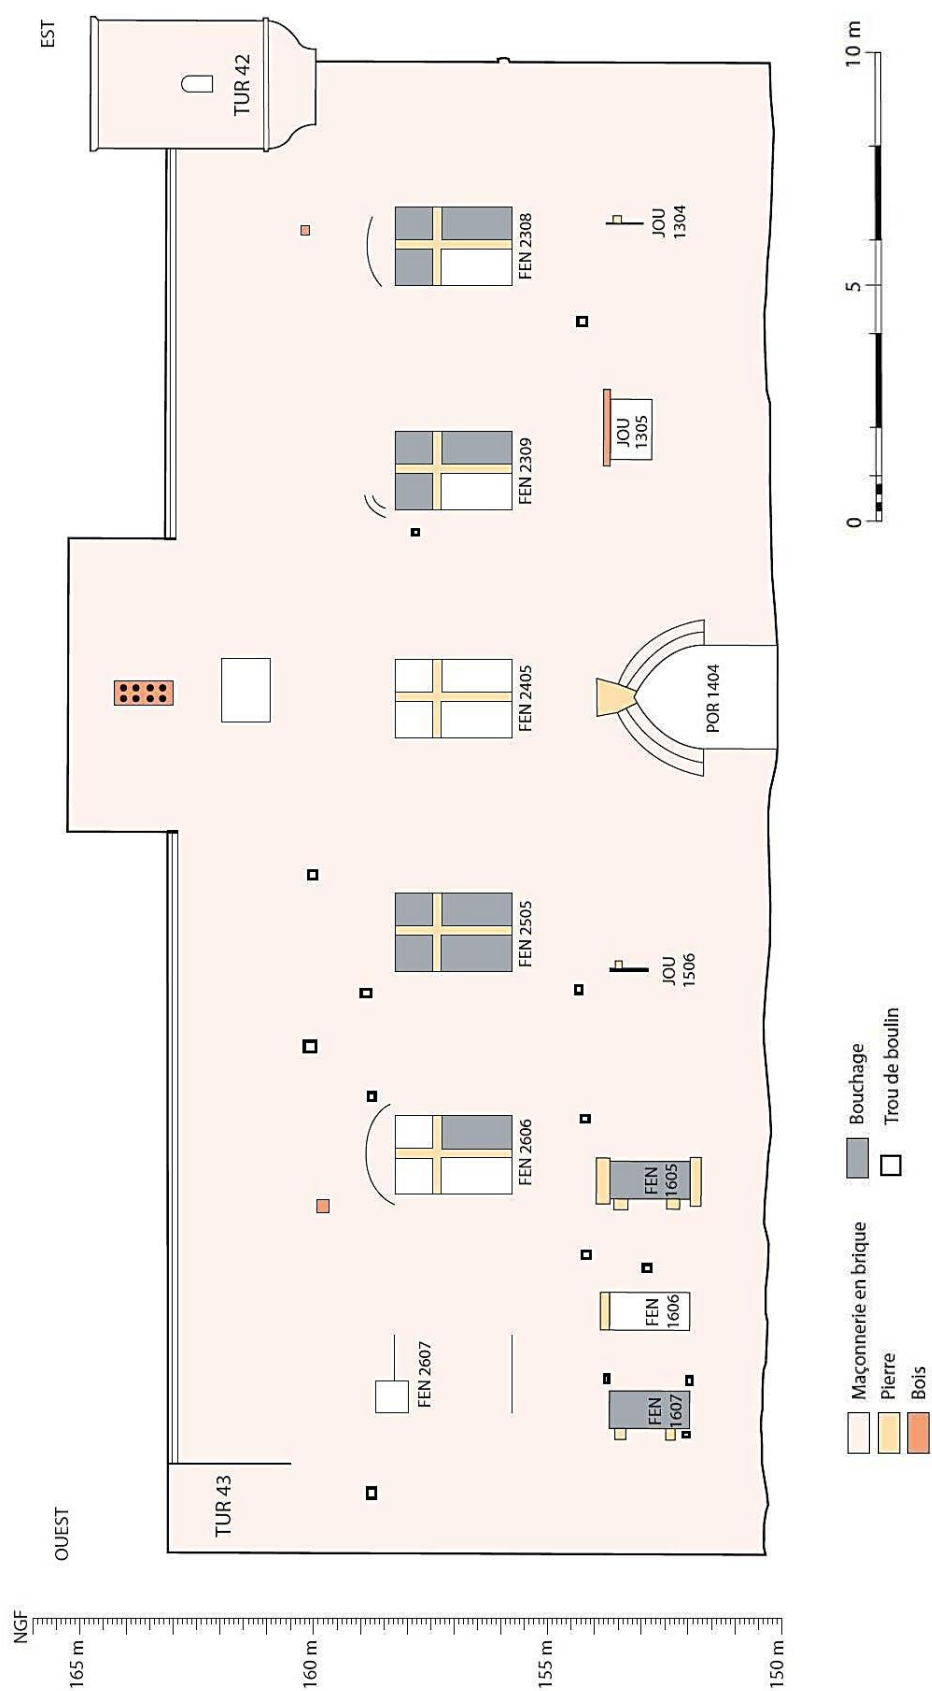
Croquis à l'échelle de la façade sud (FAC 33)
